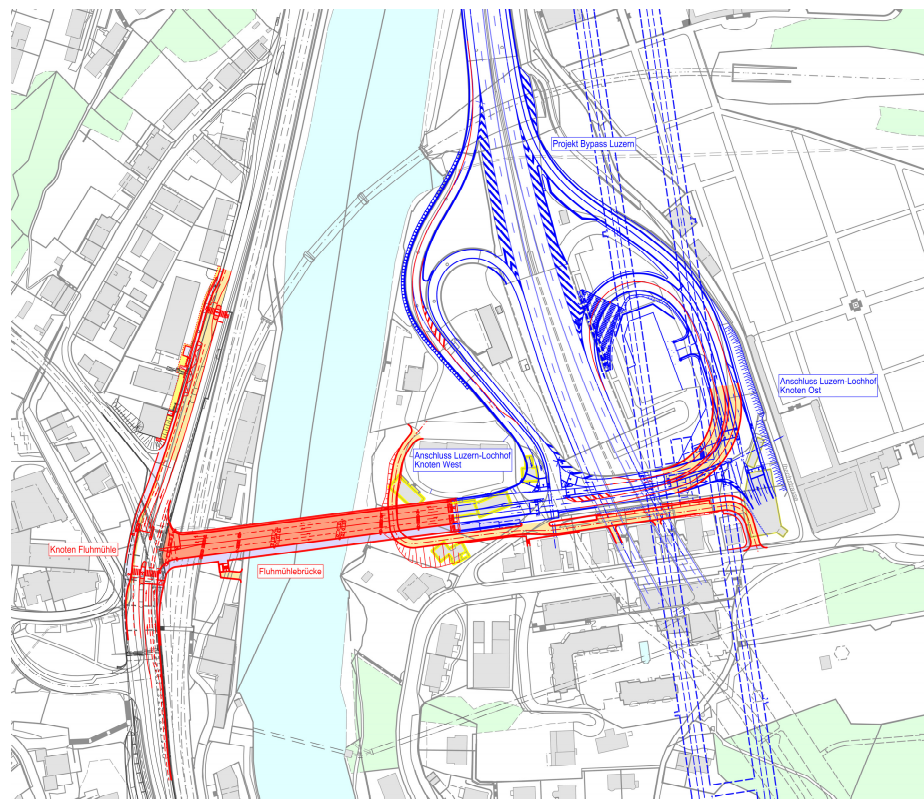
Fluhmühlebrücke mit Anschluss Luzern-Lochhof (blau: Drittprojekt ASTRA, ohne Detailanpassungen)
